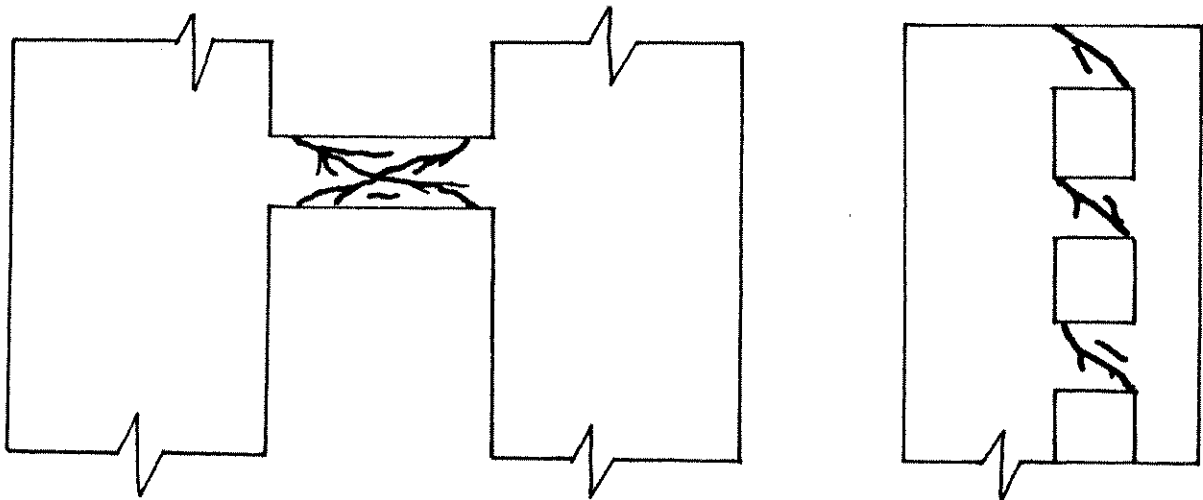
Falla en viga por mala estructuración y unión a elementos de gran rigidez.
